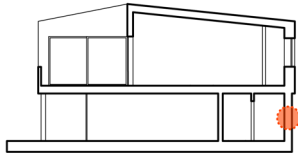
Außenwandkonstruktion EG | Variante 01 und 02 | M 1:10
